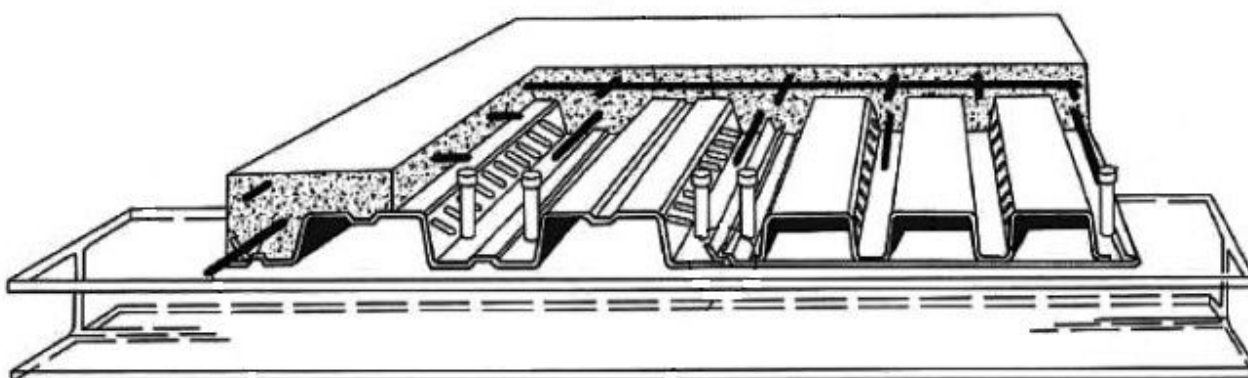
Сталежелезобетонная плита с профилированным настилом
